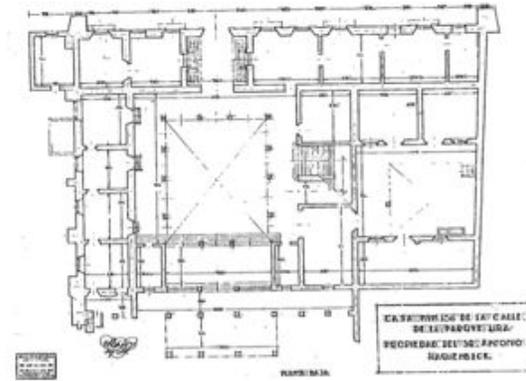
Planta arquitectónica, Casa de la Bola, Tacubaya³⁷.
